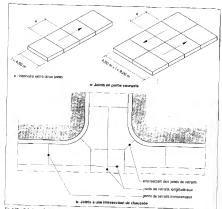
• Calepinage des joints de retraits d'une chaussée en dalles de béton non armé.
